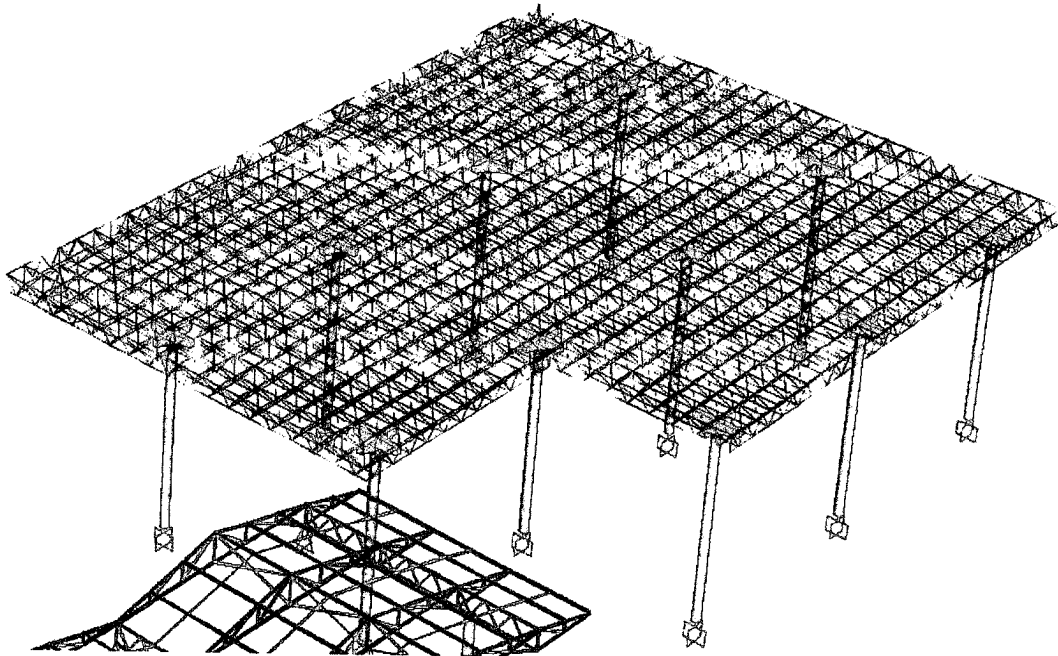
, Detalle modelado de estructura metálica tipo tridilosa grande.
